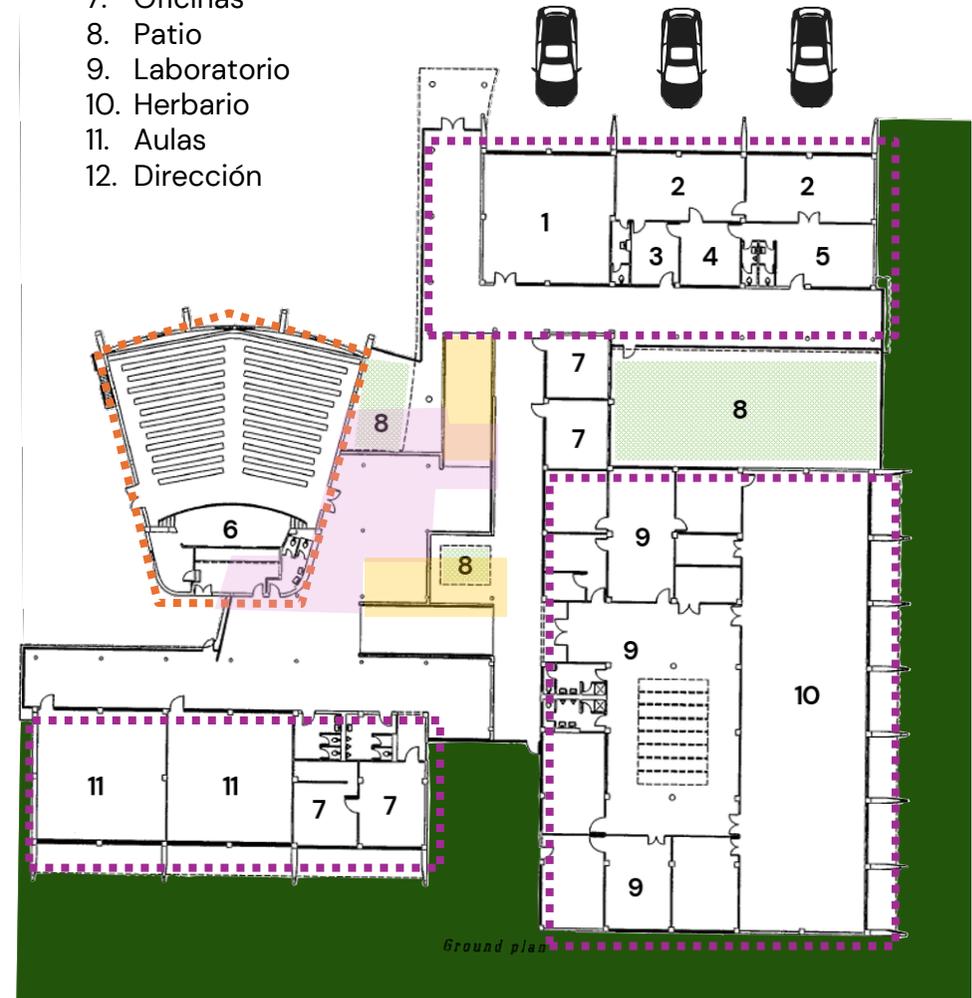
Planta del Instituto Botánico Dr. Tobbias Láser
